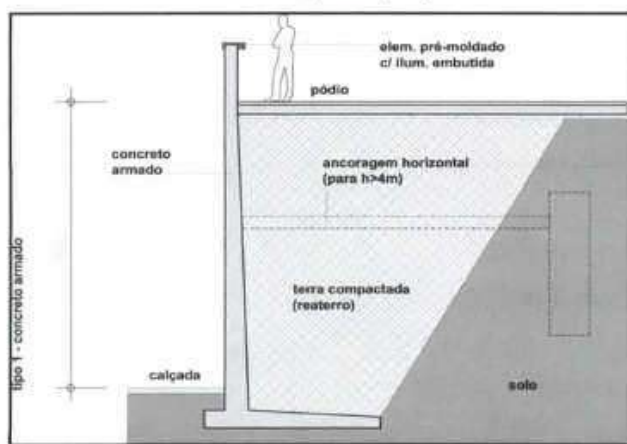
Corte típico muro, $h = 6,0 \text{ m}$
